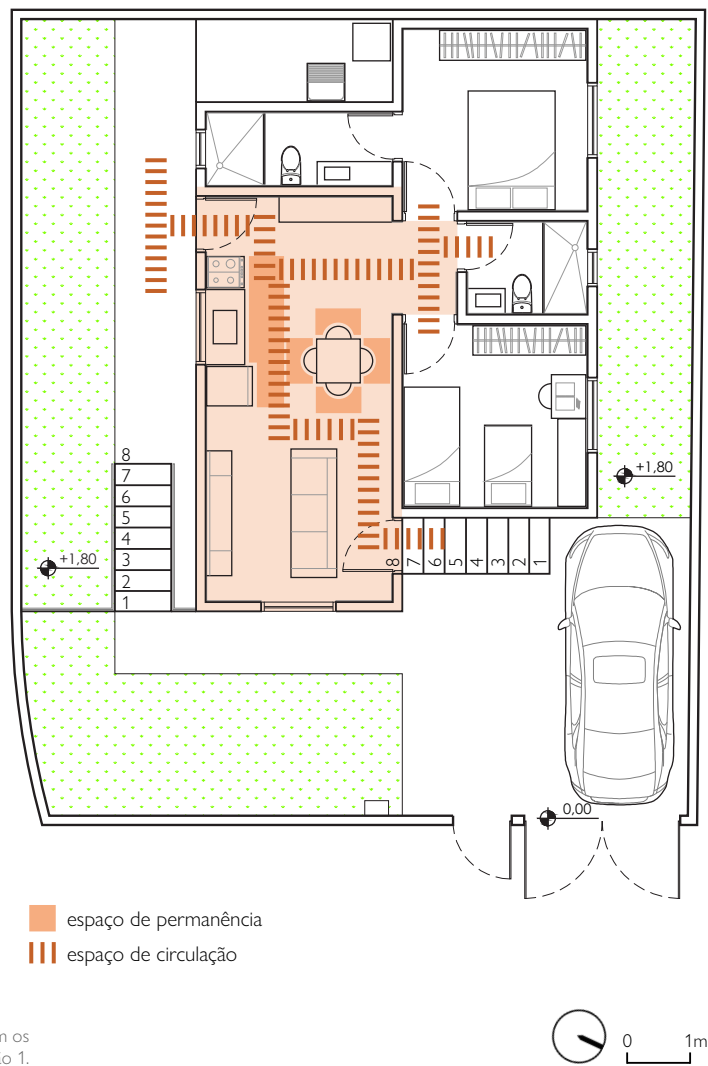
Planta com inversão lateral do banheiro e área de serviço.
